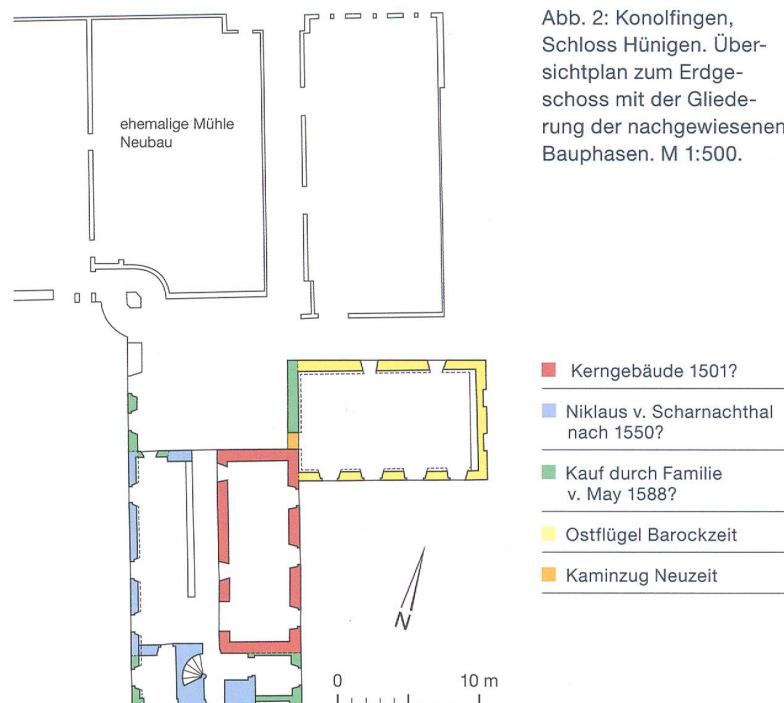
Konolfingen, Schloss Hünigen. Überblicksplan zum Erdgeschoss mit der Gliederung der nachgewiesenen Bauphasen. M 1:500.
